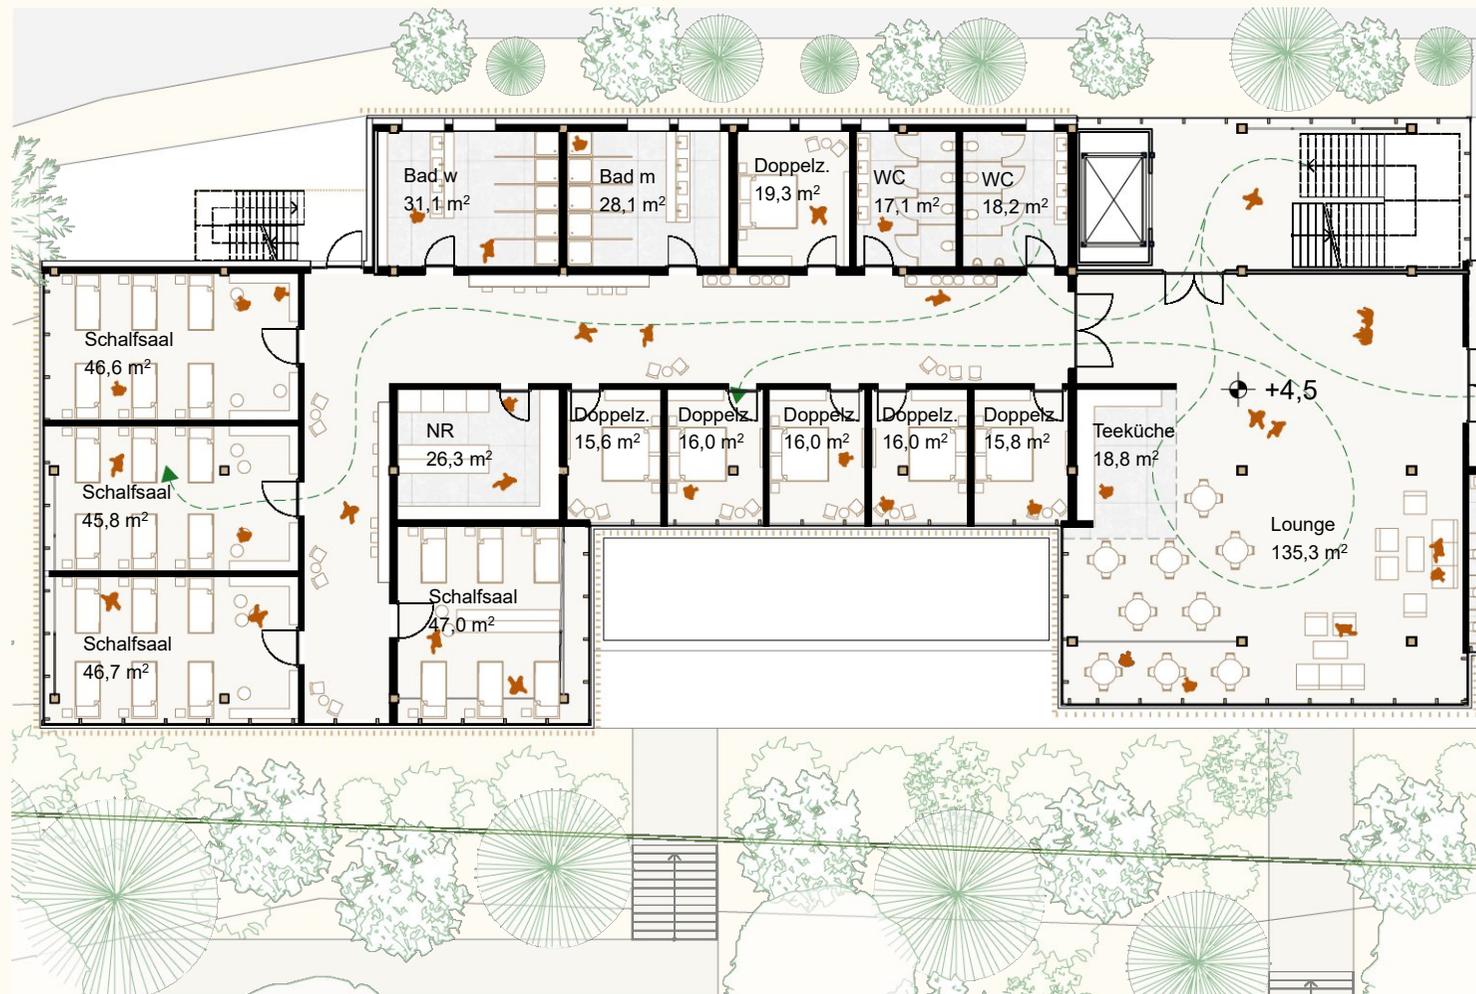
Grundriss Hostel IOG 1:200
